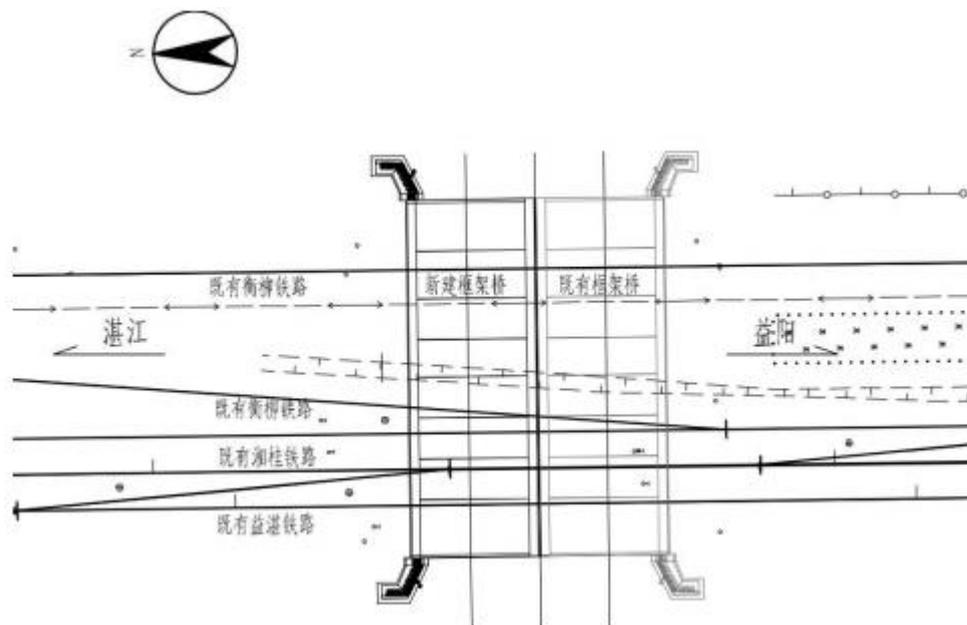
紫霞路下穿衡柳、湘桂、益湛铁路箱涵平面布置图
